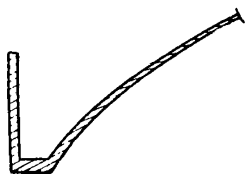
Нижний бортовой элемент цилиндрической оболочки шедового покрытия
